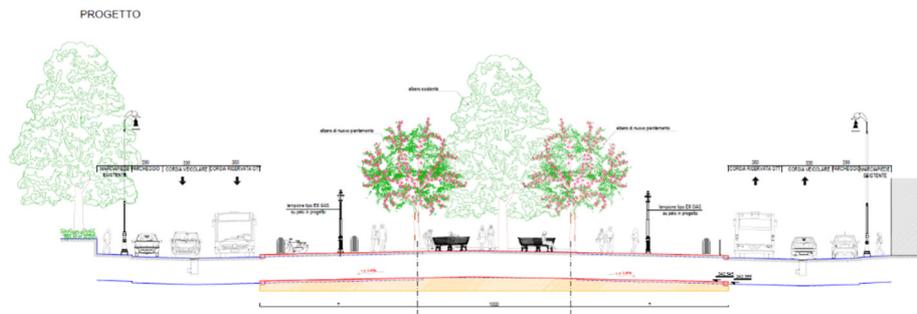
Lotto 1 Piazza Sezione A-A di progetto
